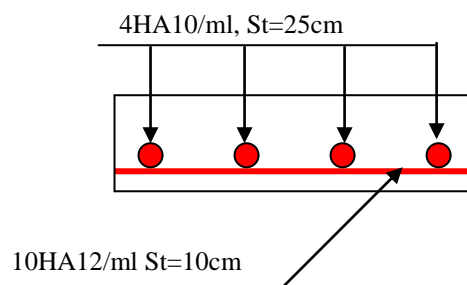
Schéma de ferrailage d'une dalle sur trois appuis
